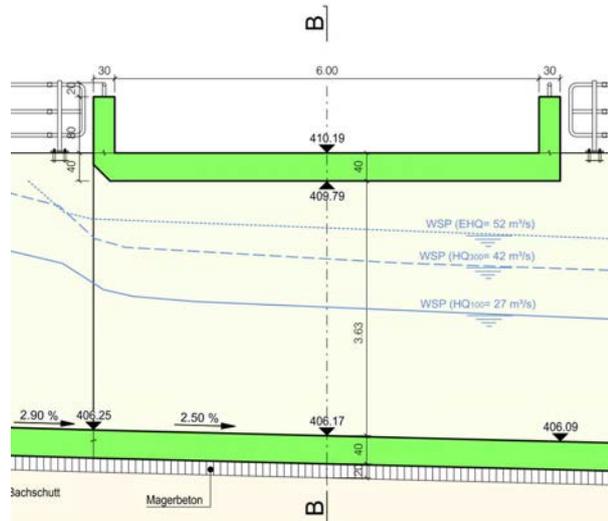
Vertikale Linienführung der Brücke Schlossbüchelsträsschen, Entlastungskanal
